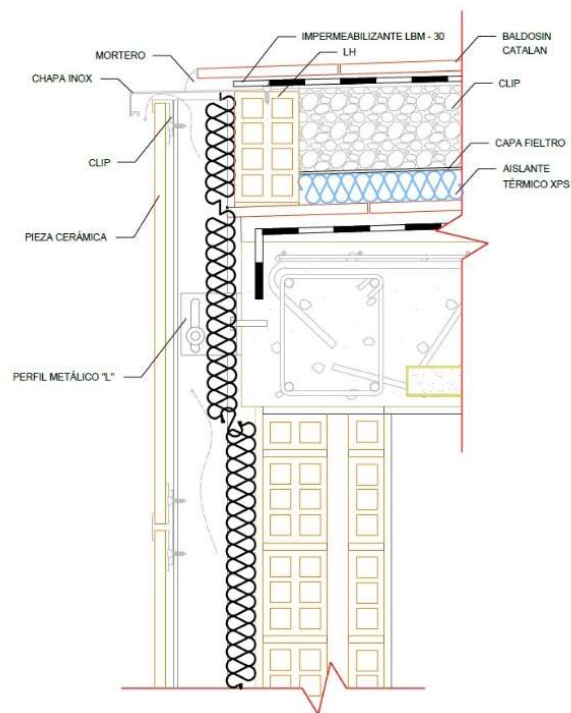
Detalle tramo final fachada ventilada, (Fuente: autor) * ver plano nº 17
